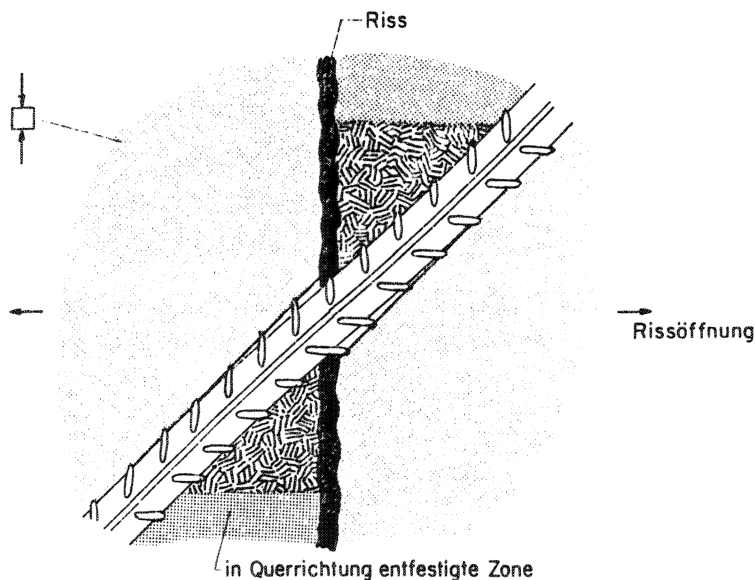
Interaktion zwischen Beton und Bewehrung beim Riss
